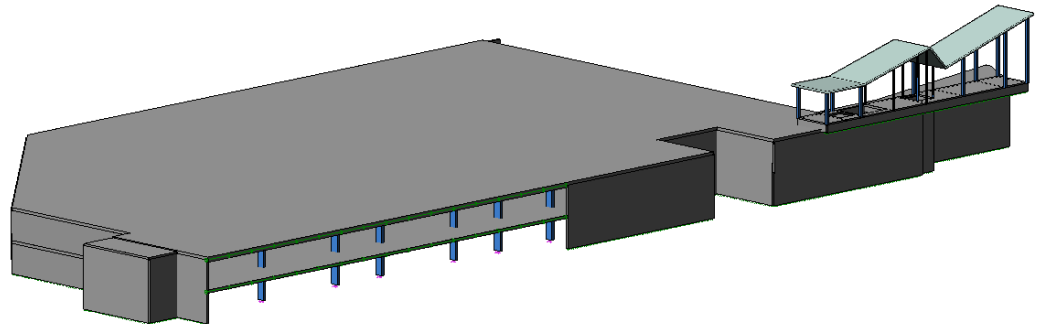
Vista assonometrica di insieme pilastri e muri -FASE 2
